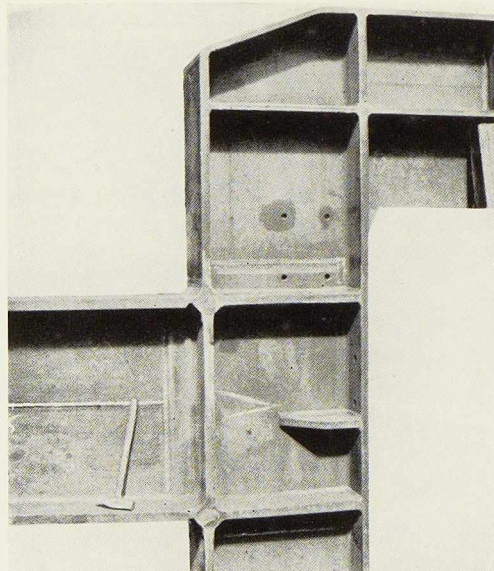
Assemblage par soudure en atelier du nœud de la figure 5.
